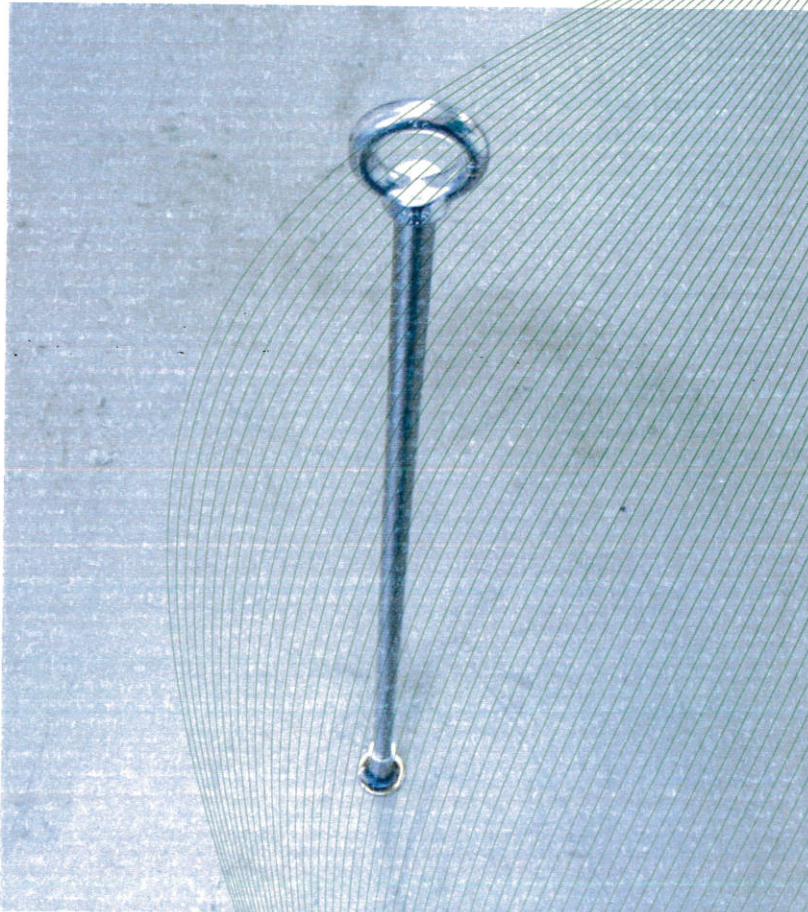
Anschlageinrichtung, Typ: Primo 6 AD
